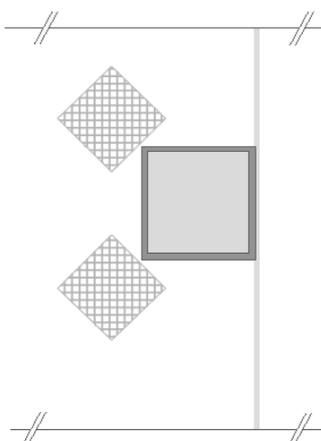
Positionnement des renforts d'angle au droit d'un coffrage
